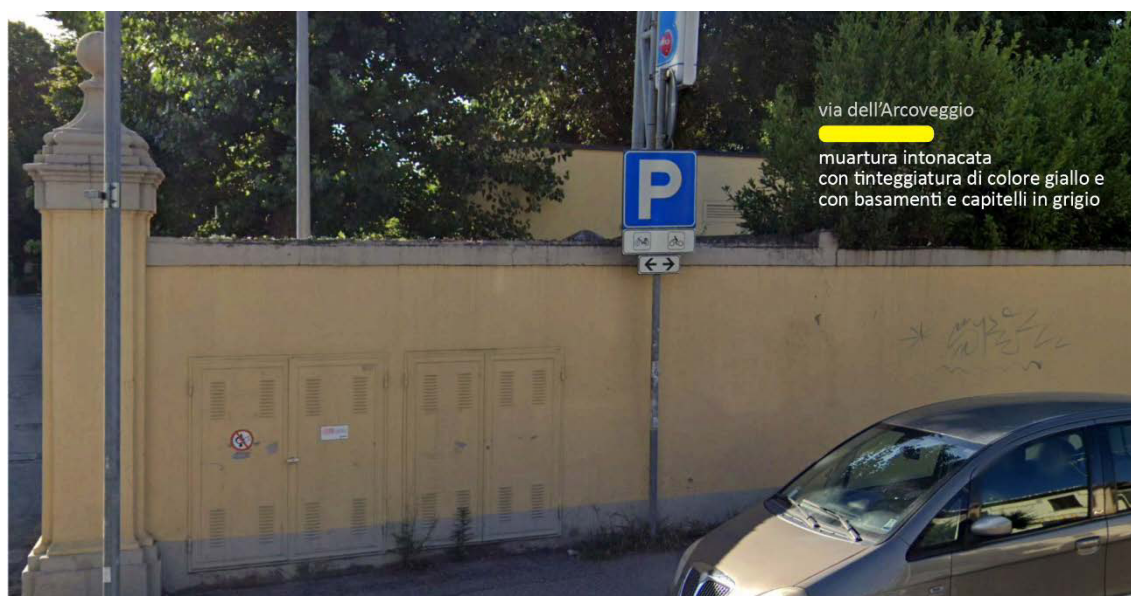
Vista del muro di recinzione su via dell'Arcoveggio
